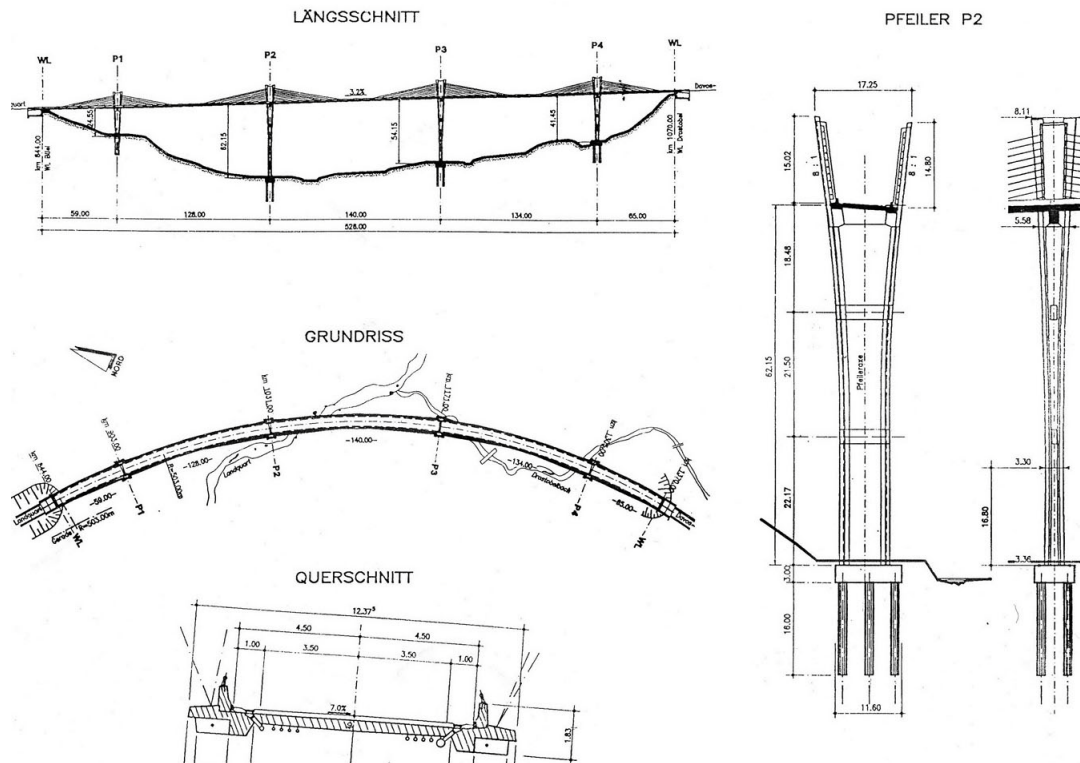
Sunniberg-Brücke bei Klosters. GR - Längsschnitt. Grundriss und Schnitte
